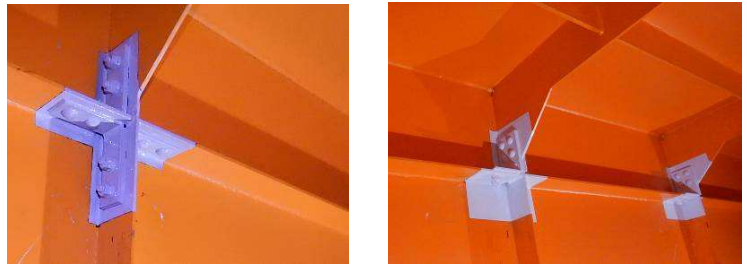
垂直補剛材溶接部(左)及び水平補剛材(右) 施工状況
